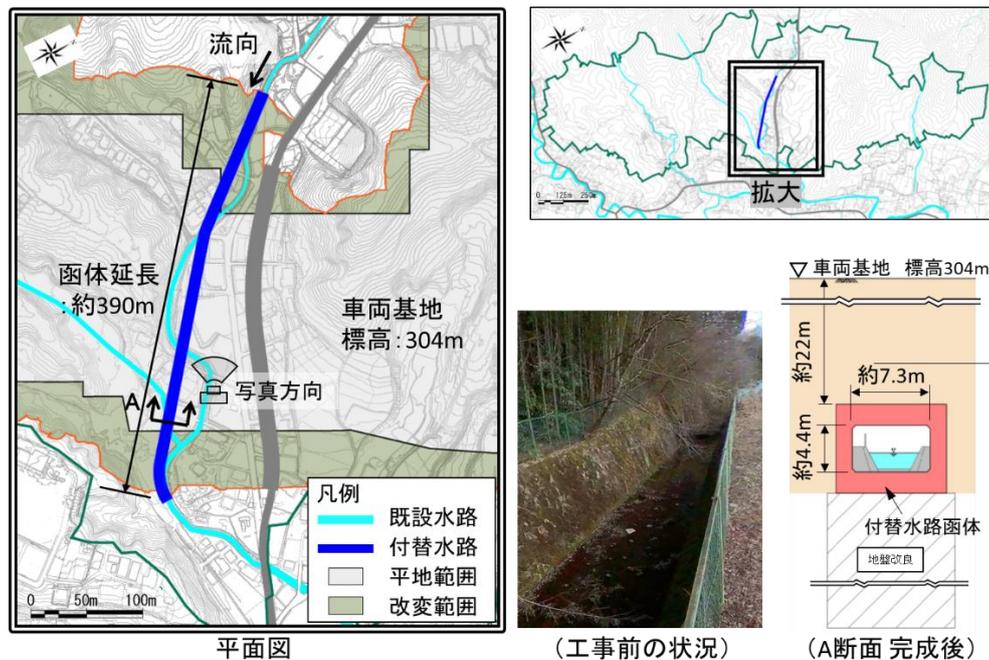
付替水路工（谷戸沢）の施工概要
